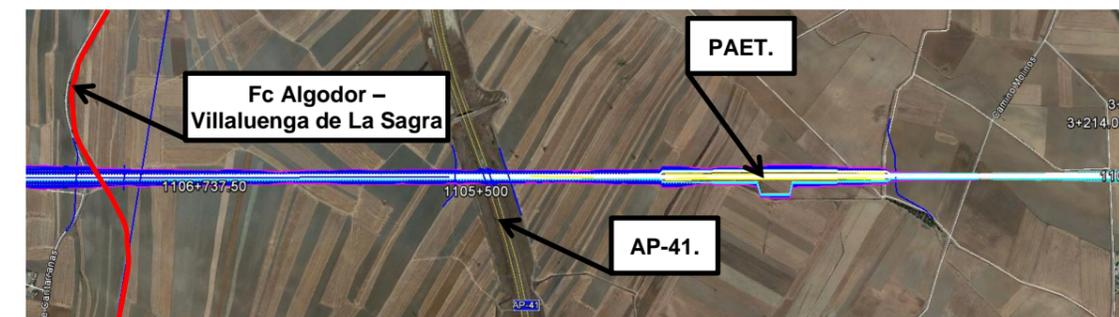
Cruce de la LAV (Alternativa I.1) bajo AP-41 y FC Algodor – Villaluenga de La Sagra y ubicación del Puesto de Adelantamiento y Estacionamiento Técnico.
